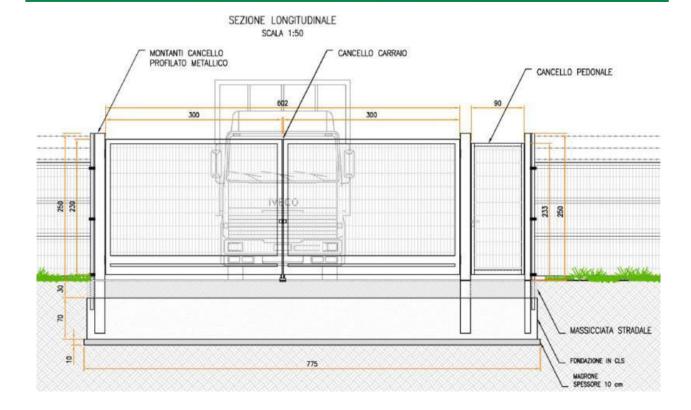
Sezione longitudinale accesso carraio e pedonale
